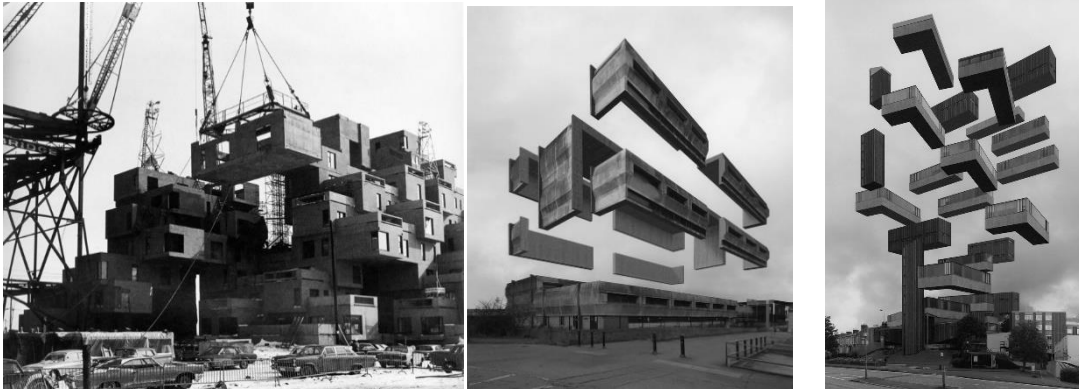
Sistemas constructivos prefabricados aplicables a la construcción de edificaciones en países en desarrollo (2010)
